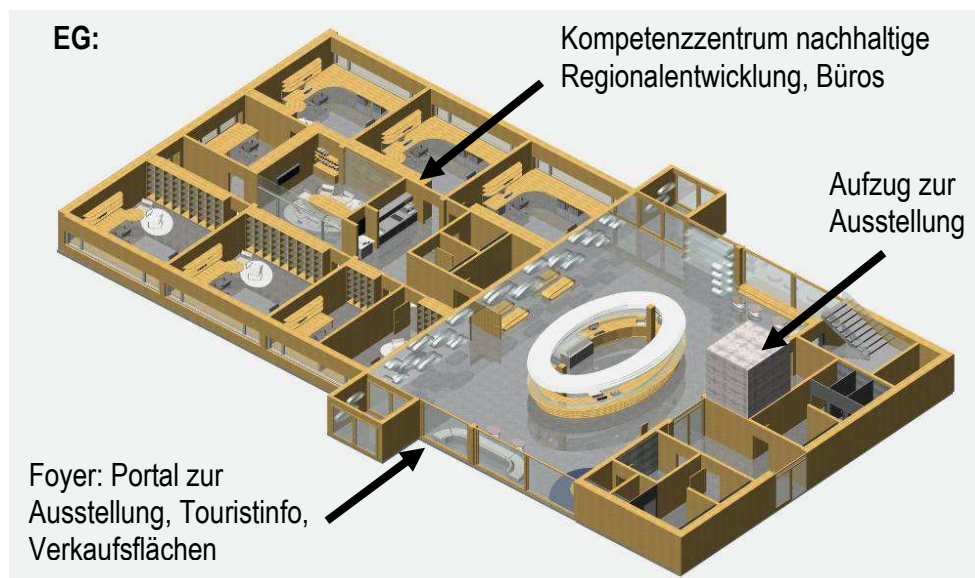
Grundrissplan Erdgeschoß mit Funktionszuteilung
